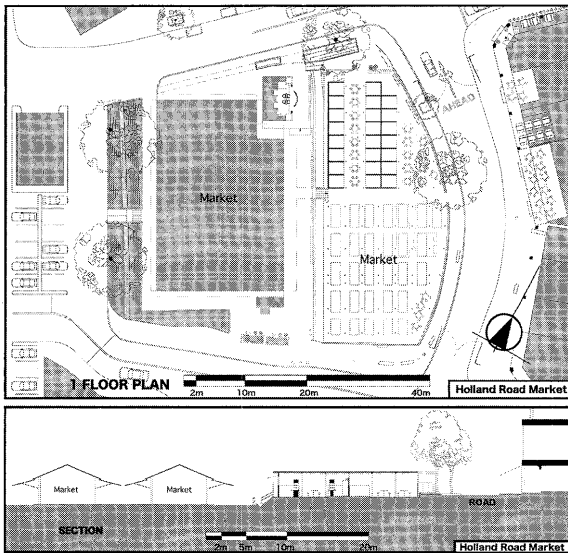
(左列):再配置時代の(12)Holland Road Marketの平面・立面図
